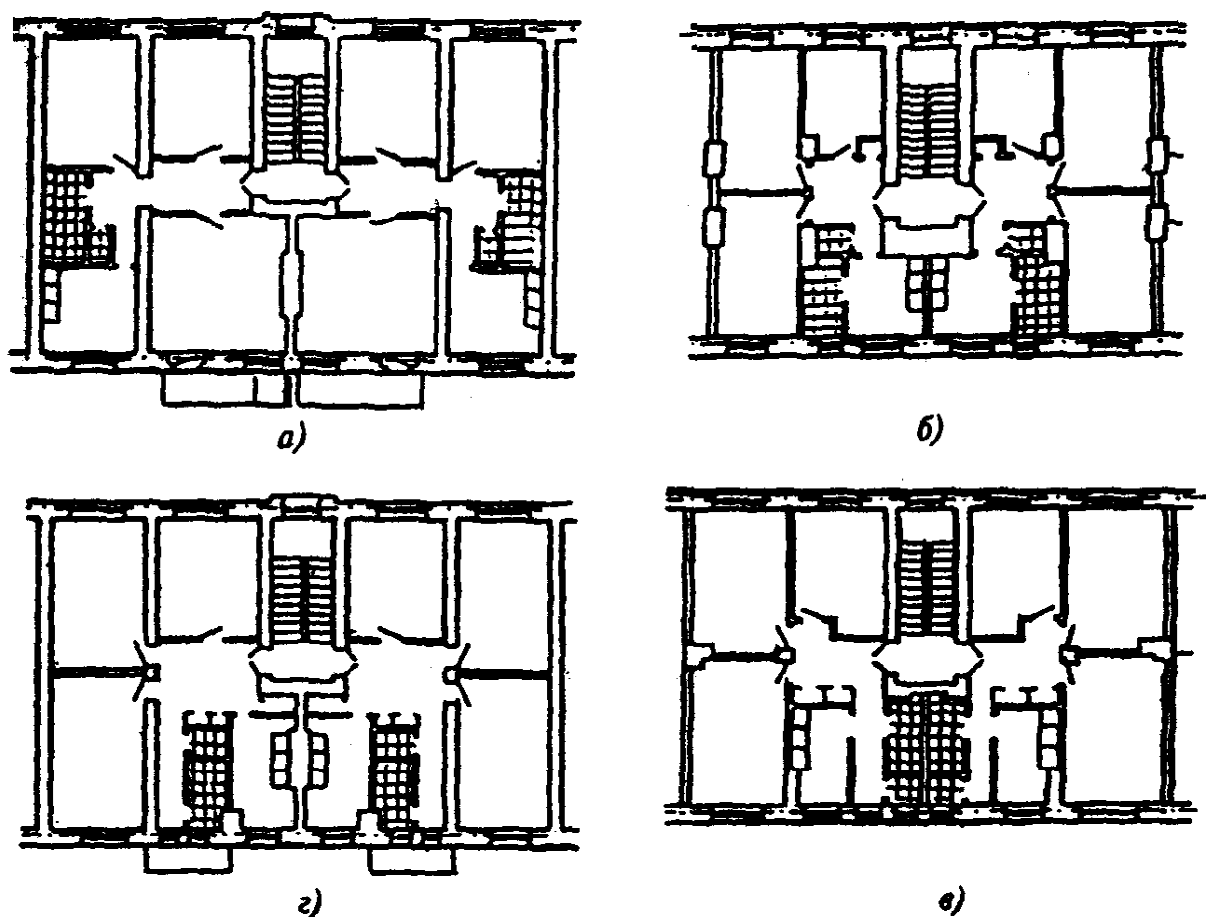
Плани типового поверху будинків п'ятого виду масової забудови перших десятиліть радянської влади:
